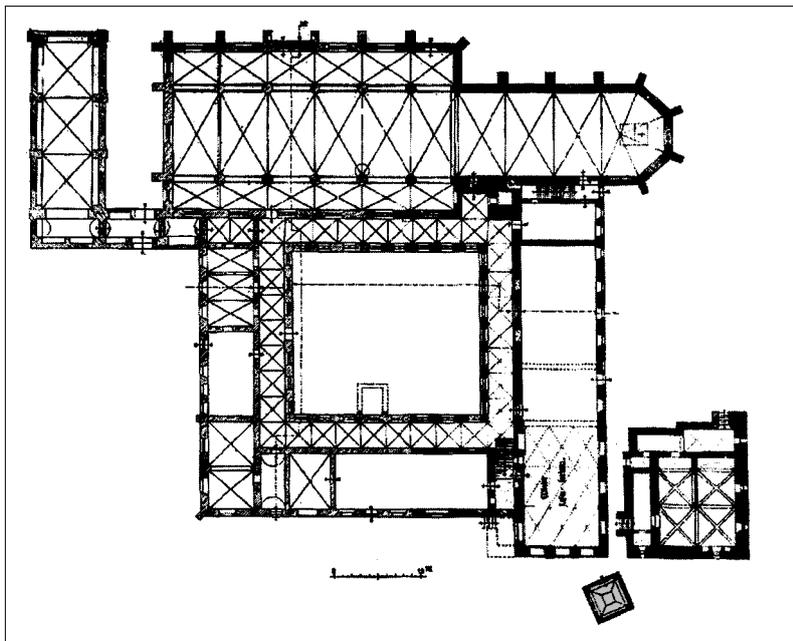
(links): Stadt Brandenburg, Dominikanerkloster, Grundriss von P. Eichholz 1912.
